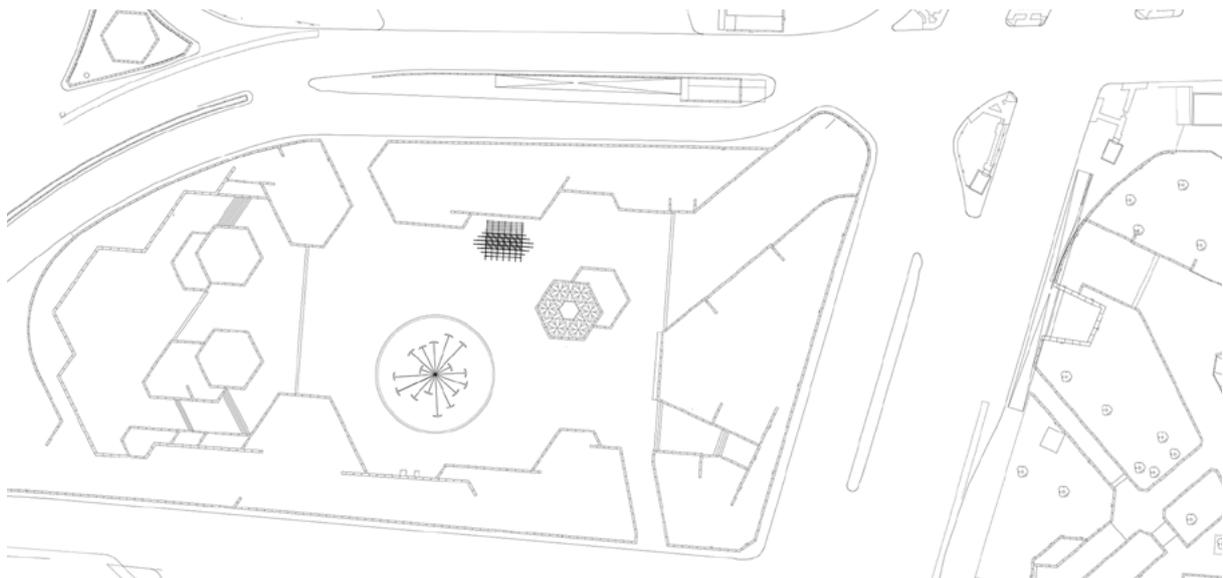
Lageplan Ebertplatz nach studentischem design-build Projekt.
